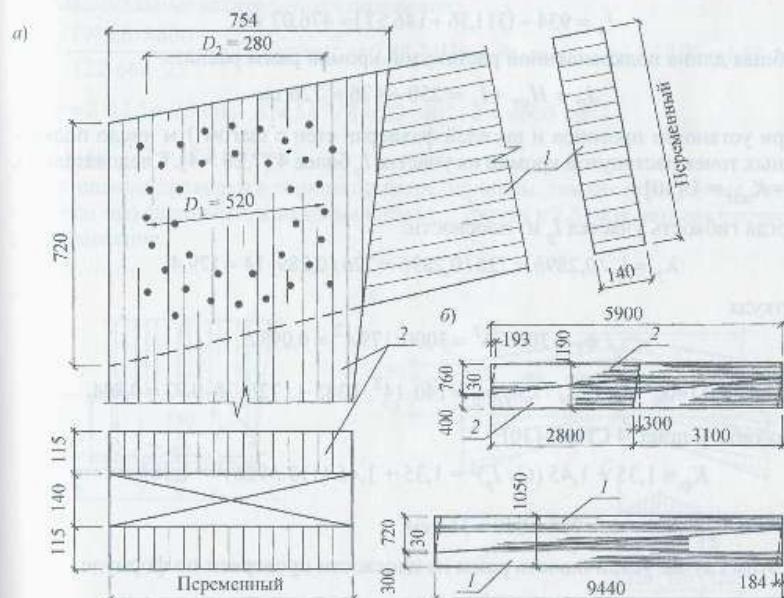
Основные элементы рамы: а – карнизный узел; б – заготовочные блоки постоянной высоты для раскрытия на стойки 2 и полуригели 1
